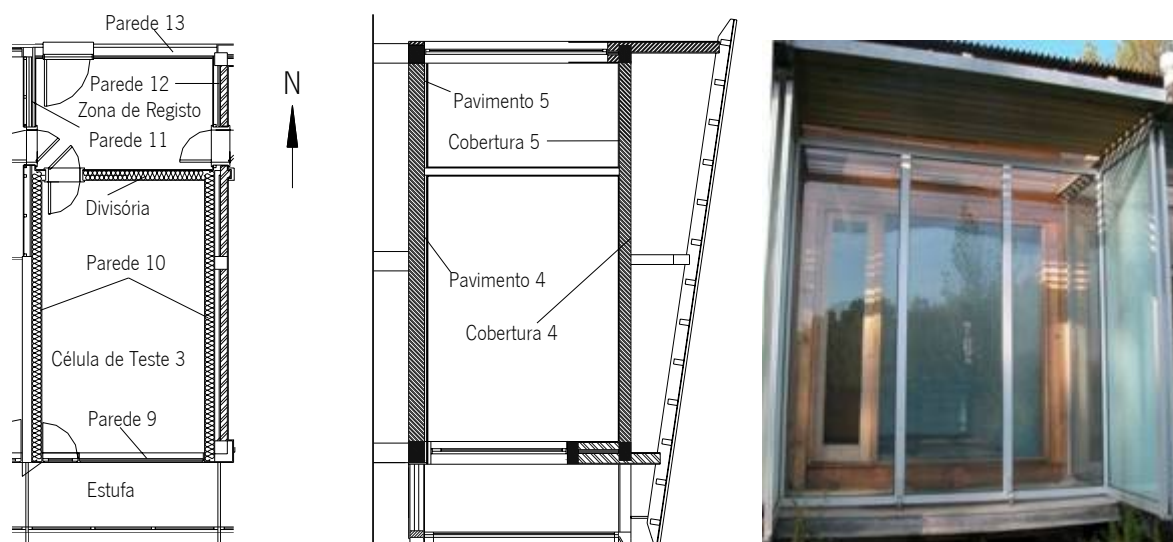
Planta, alçado e foto da fachada Sul da Célula de Teste tipo Passys
